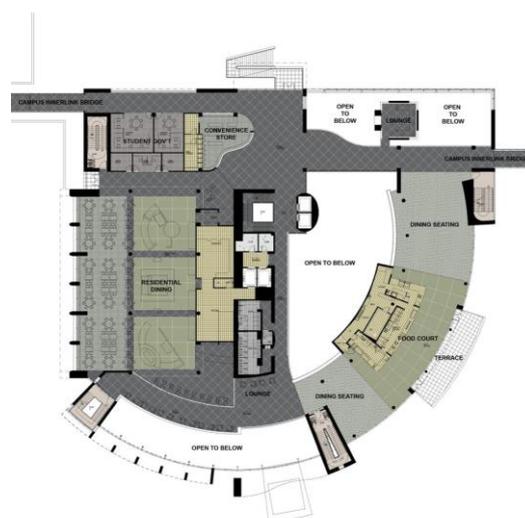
7 Denah lantai 1 CSU Student Center
